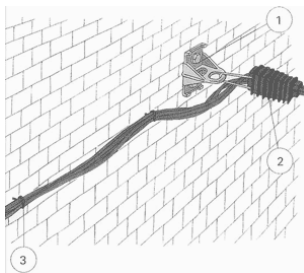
Арматура для прокладки СИП по фасадам зданий: 1 — кронштейн СА 1500; 2 — анкерный зажим для проводов абонентов РА 25x100; 3 — арматура для прокладки по фасадам BRPF70-150-1F (1 шт./0,7 м)
